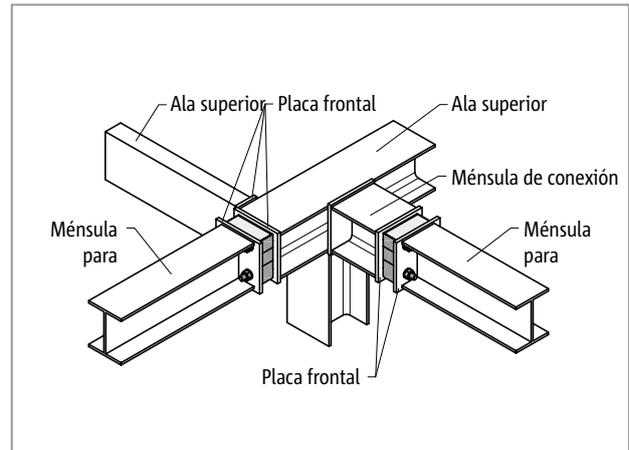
Schöck Isokorb® T tipo S: Esquinero externo
